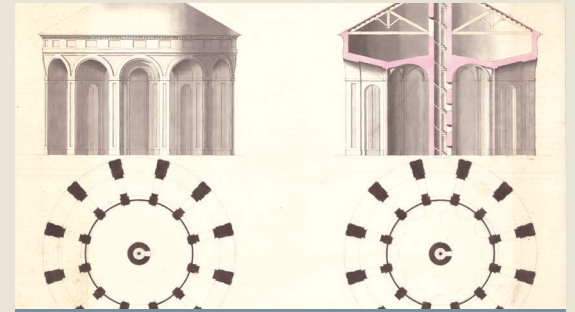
Elevation et coupe du Château d'eau*, Giuseppe Battista Piacenza, 1808, Politecnico di Torino.
